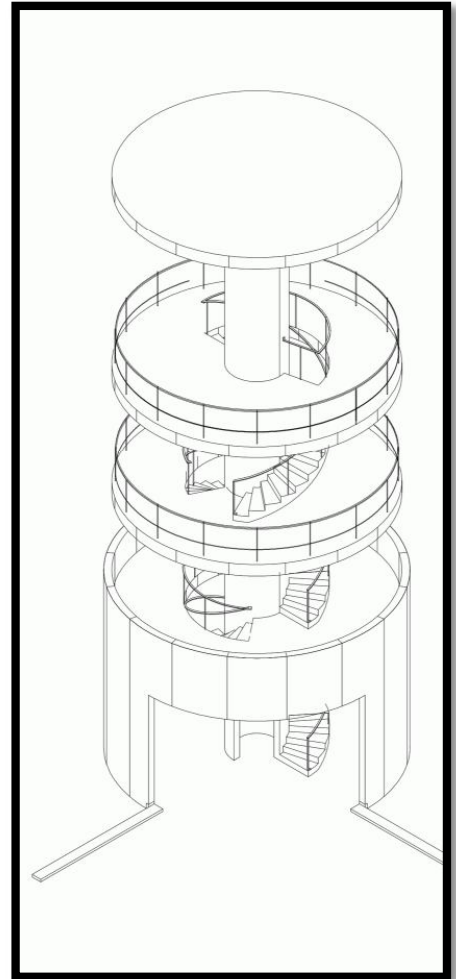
Torre de secado. Fuente arqdaily.com
